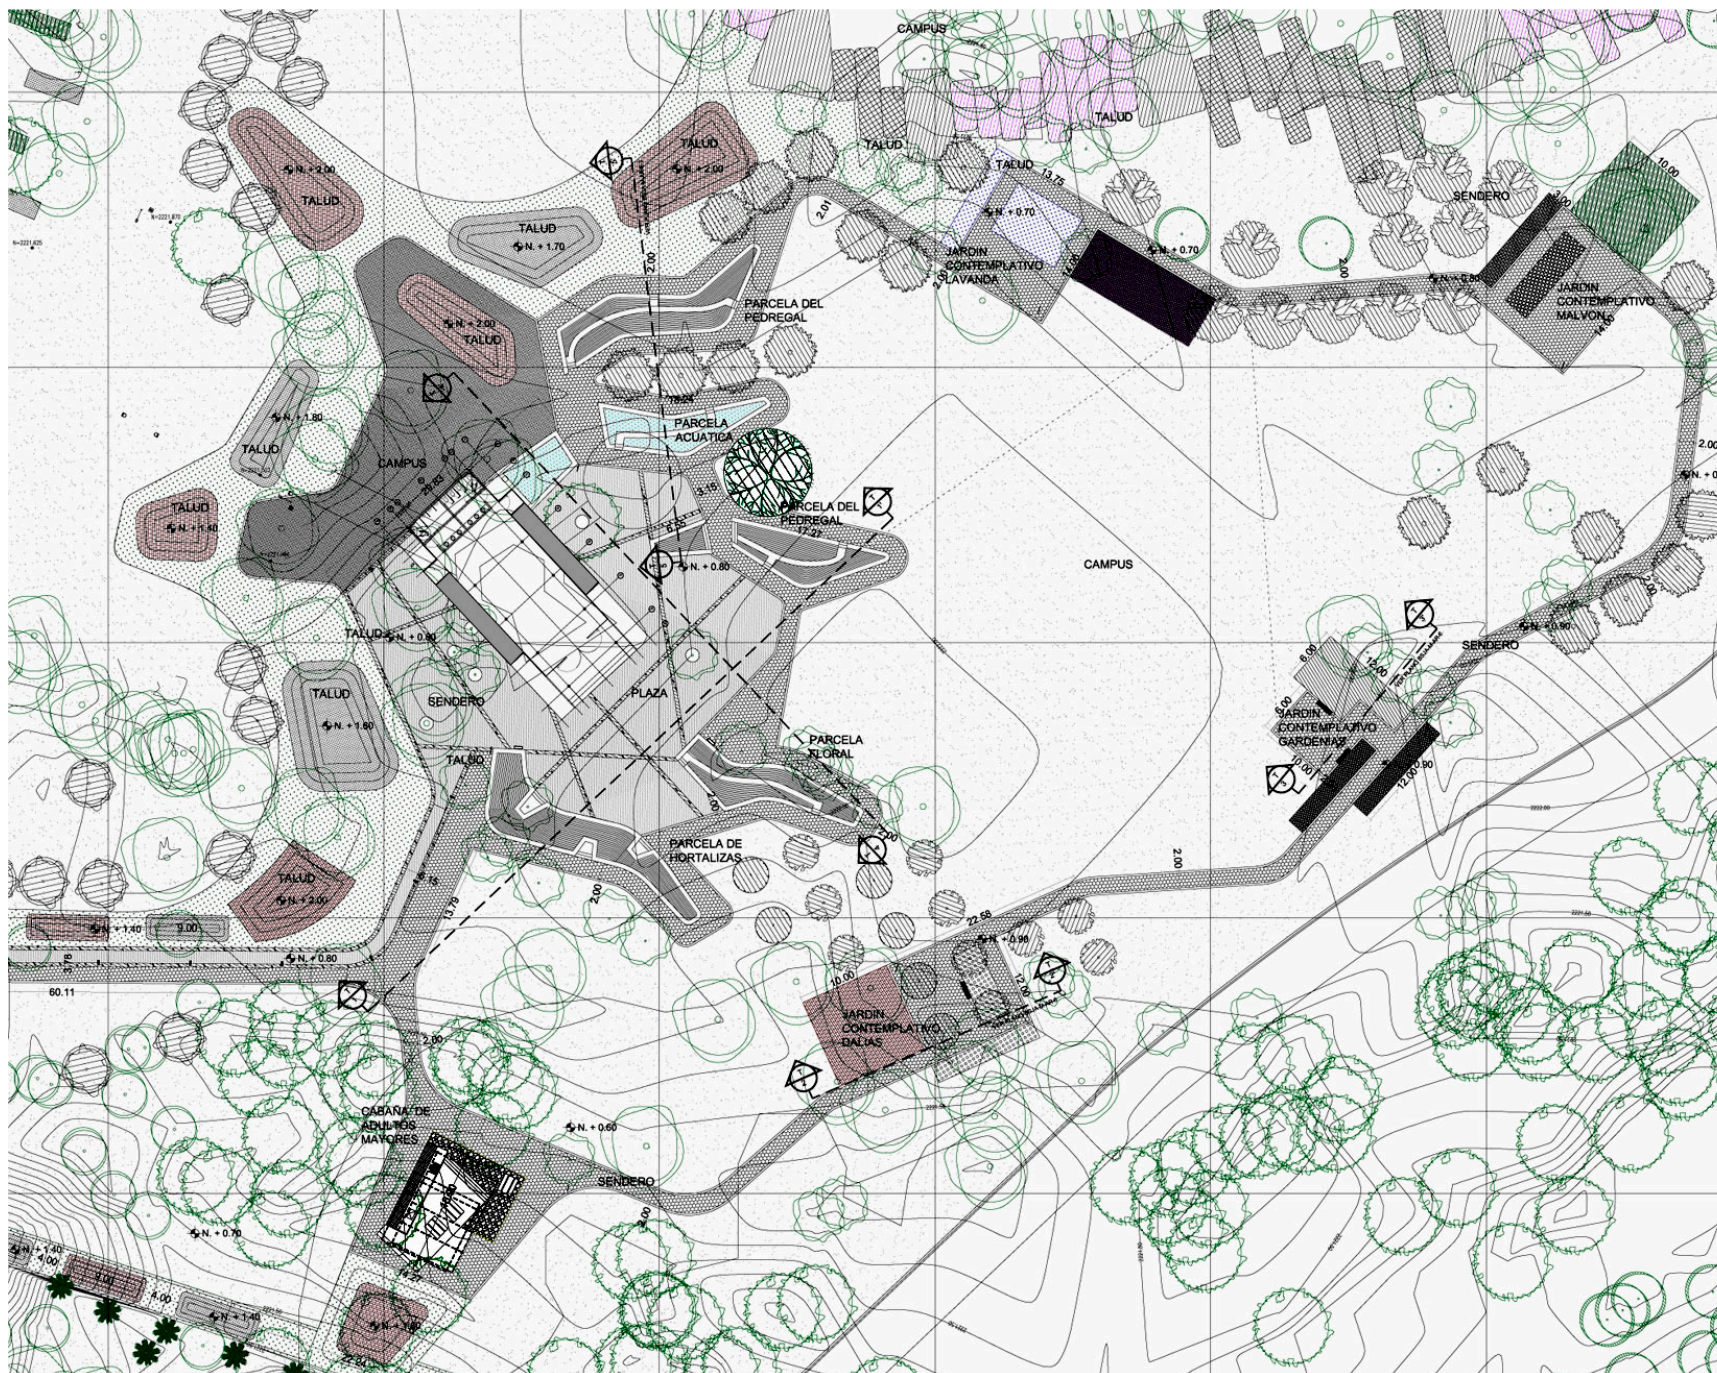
BSJA Zona IV. Planta del proyecto ejecutivo del jardín de adultos mayores
